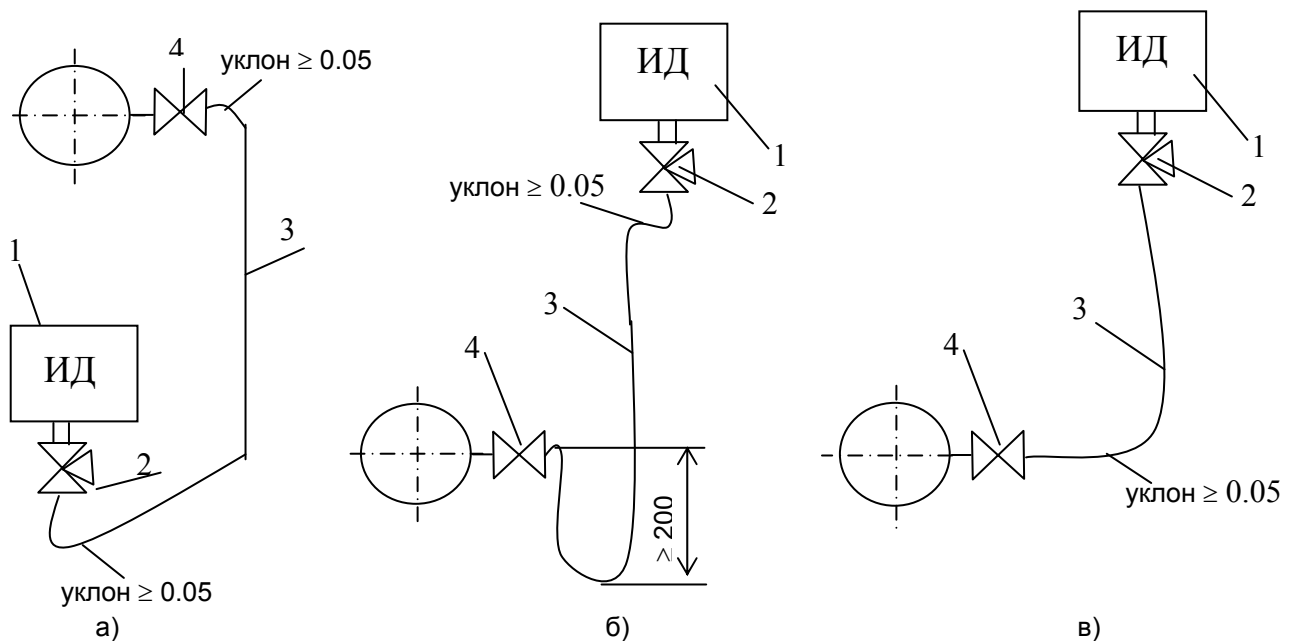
Установка датчика для измерения давления неагрессивной жидкости
